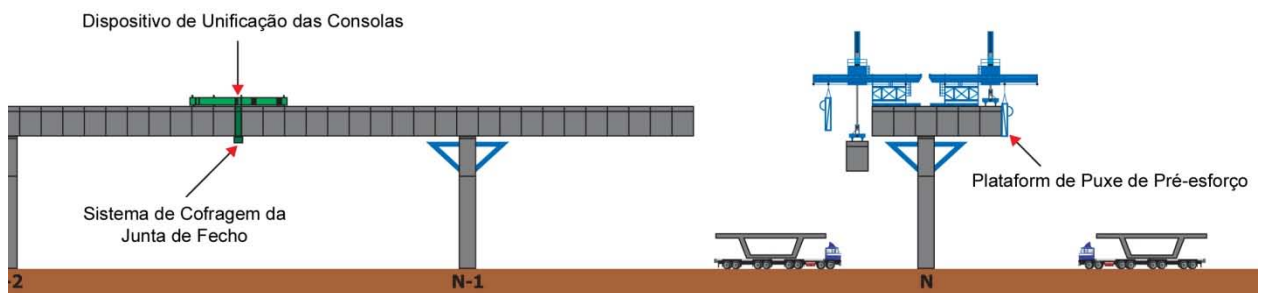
Esquemática do processo construtivo com recurso a guinchos de elevação.
